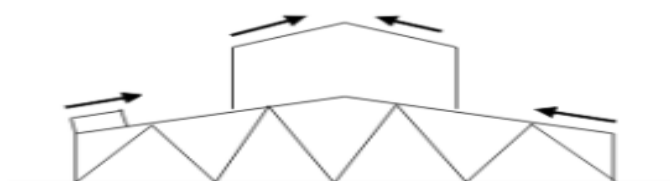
Порядок монтажа плит в зданиях с фонарями
